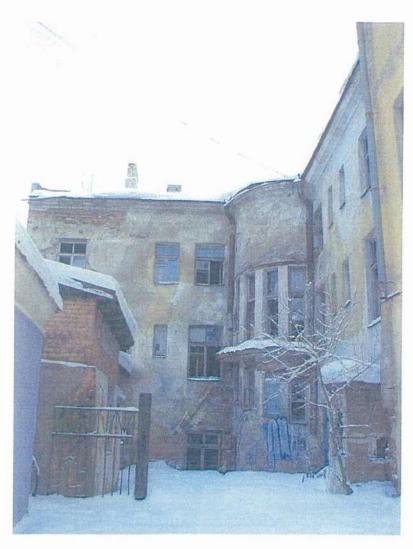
Общий вид дворовых фасадов здания. Фото с северо-запада.
